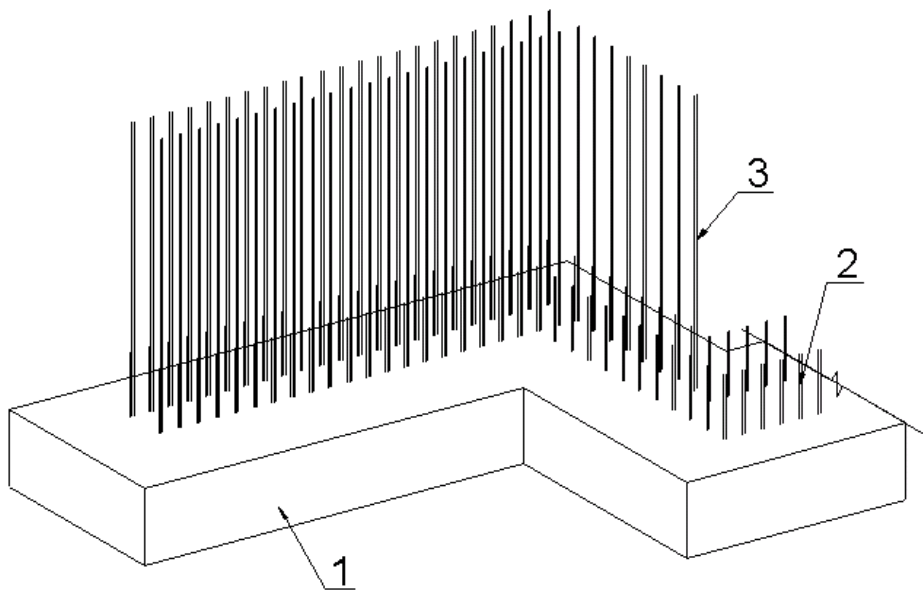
Армирование верхней части подпорной стены вертикальными отдельными стержнями. 1 – готовая нижняя часть подпорной стены, 2 – арматурные выпуски из нижней части подпорной стены, 3 – арматурные стержни.
